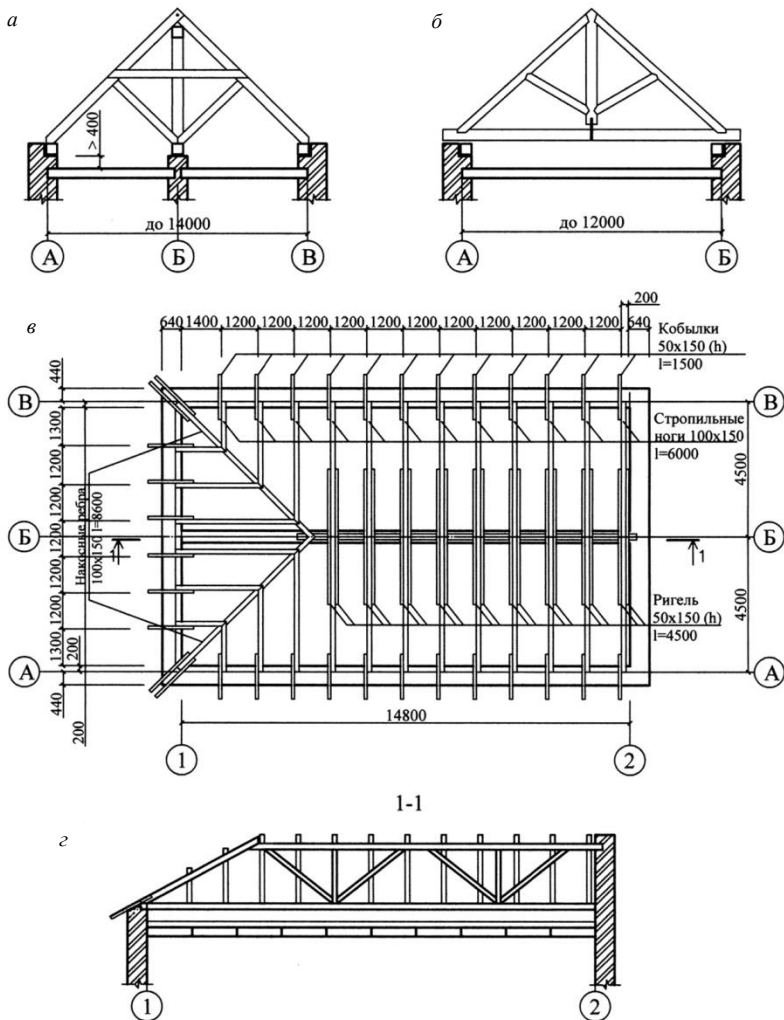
Стропильные конструкции малоэтажных зданий:
